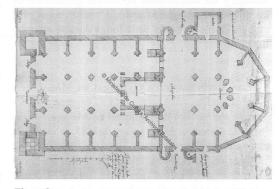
Planta de la Iglesia Catedral de Málaga (Ruiz III 1595)
